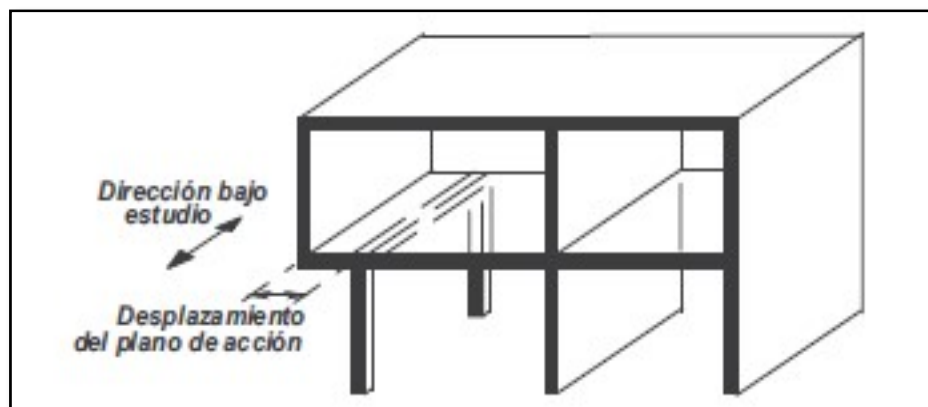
Desplazamientos del plano de acción de elementos verticales en una casa de dos plantas (NSR, 2010).
